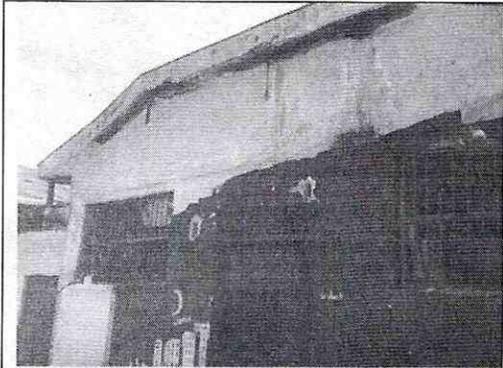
Fachada del patio interior. Manchas, descascamientos y deterioro de muro y voladizo, humedades causadas por mal estado de canaletas y bajantes de aguas lluvias.
